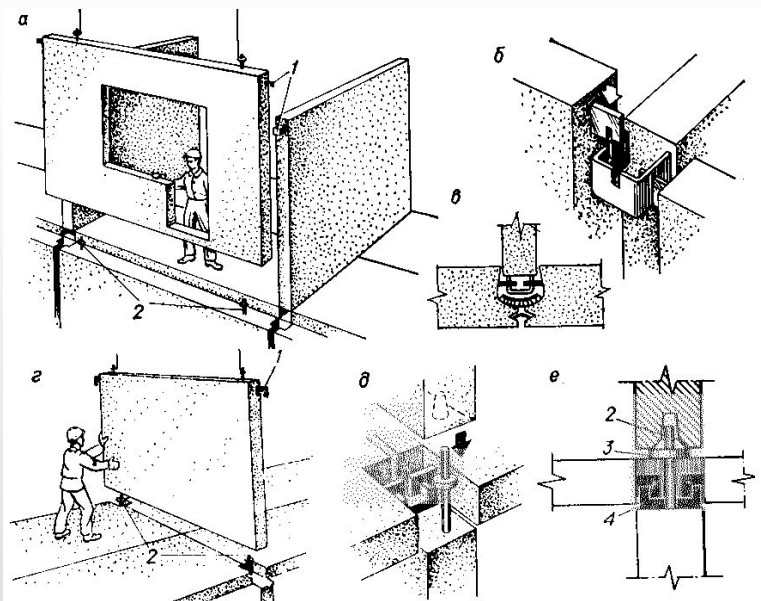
Фрагменты монтажа внутренних и наружных стеновых панелей
